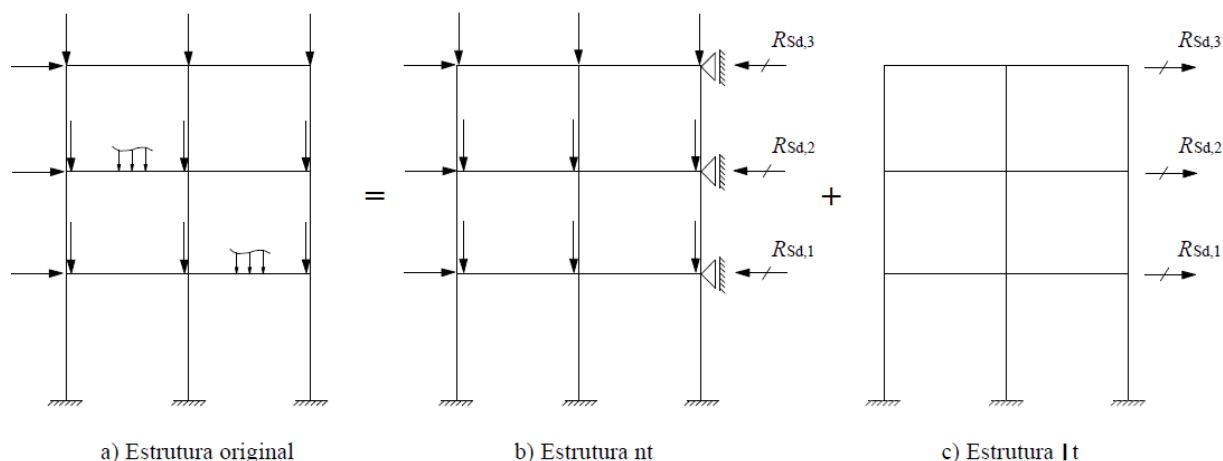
Subdivisão da estrutura original. (Fonte: NBR 8800 [3]).
